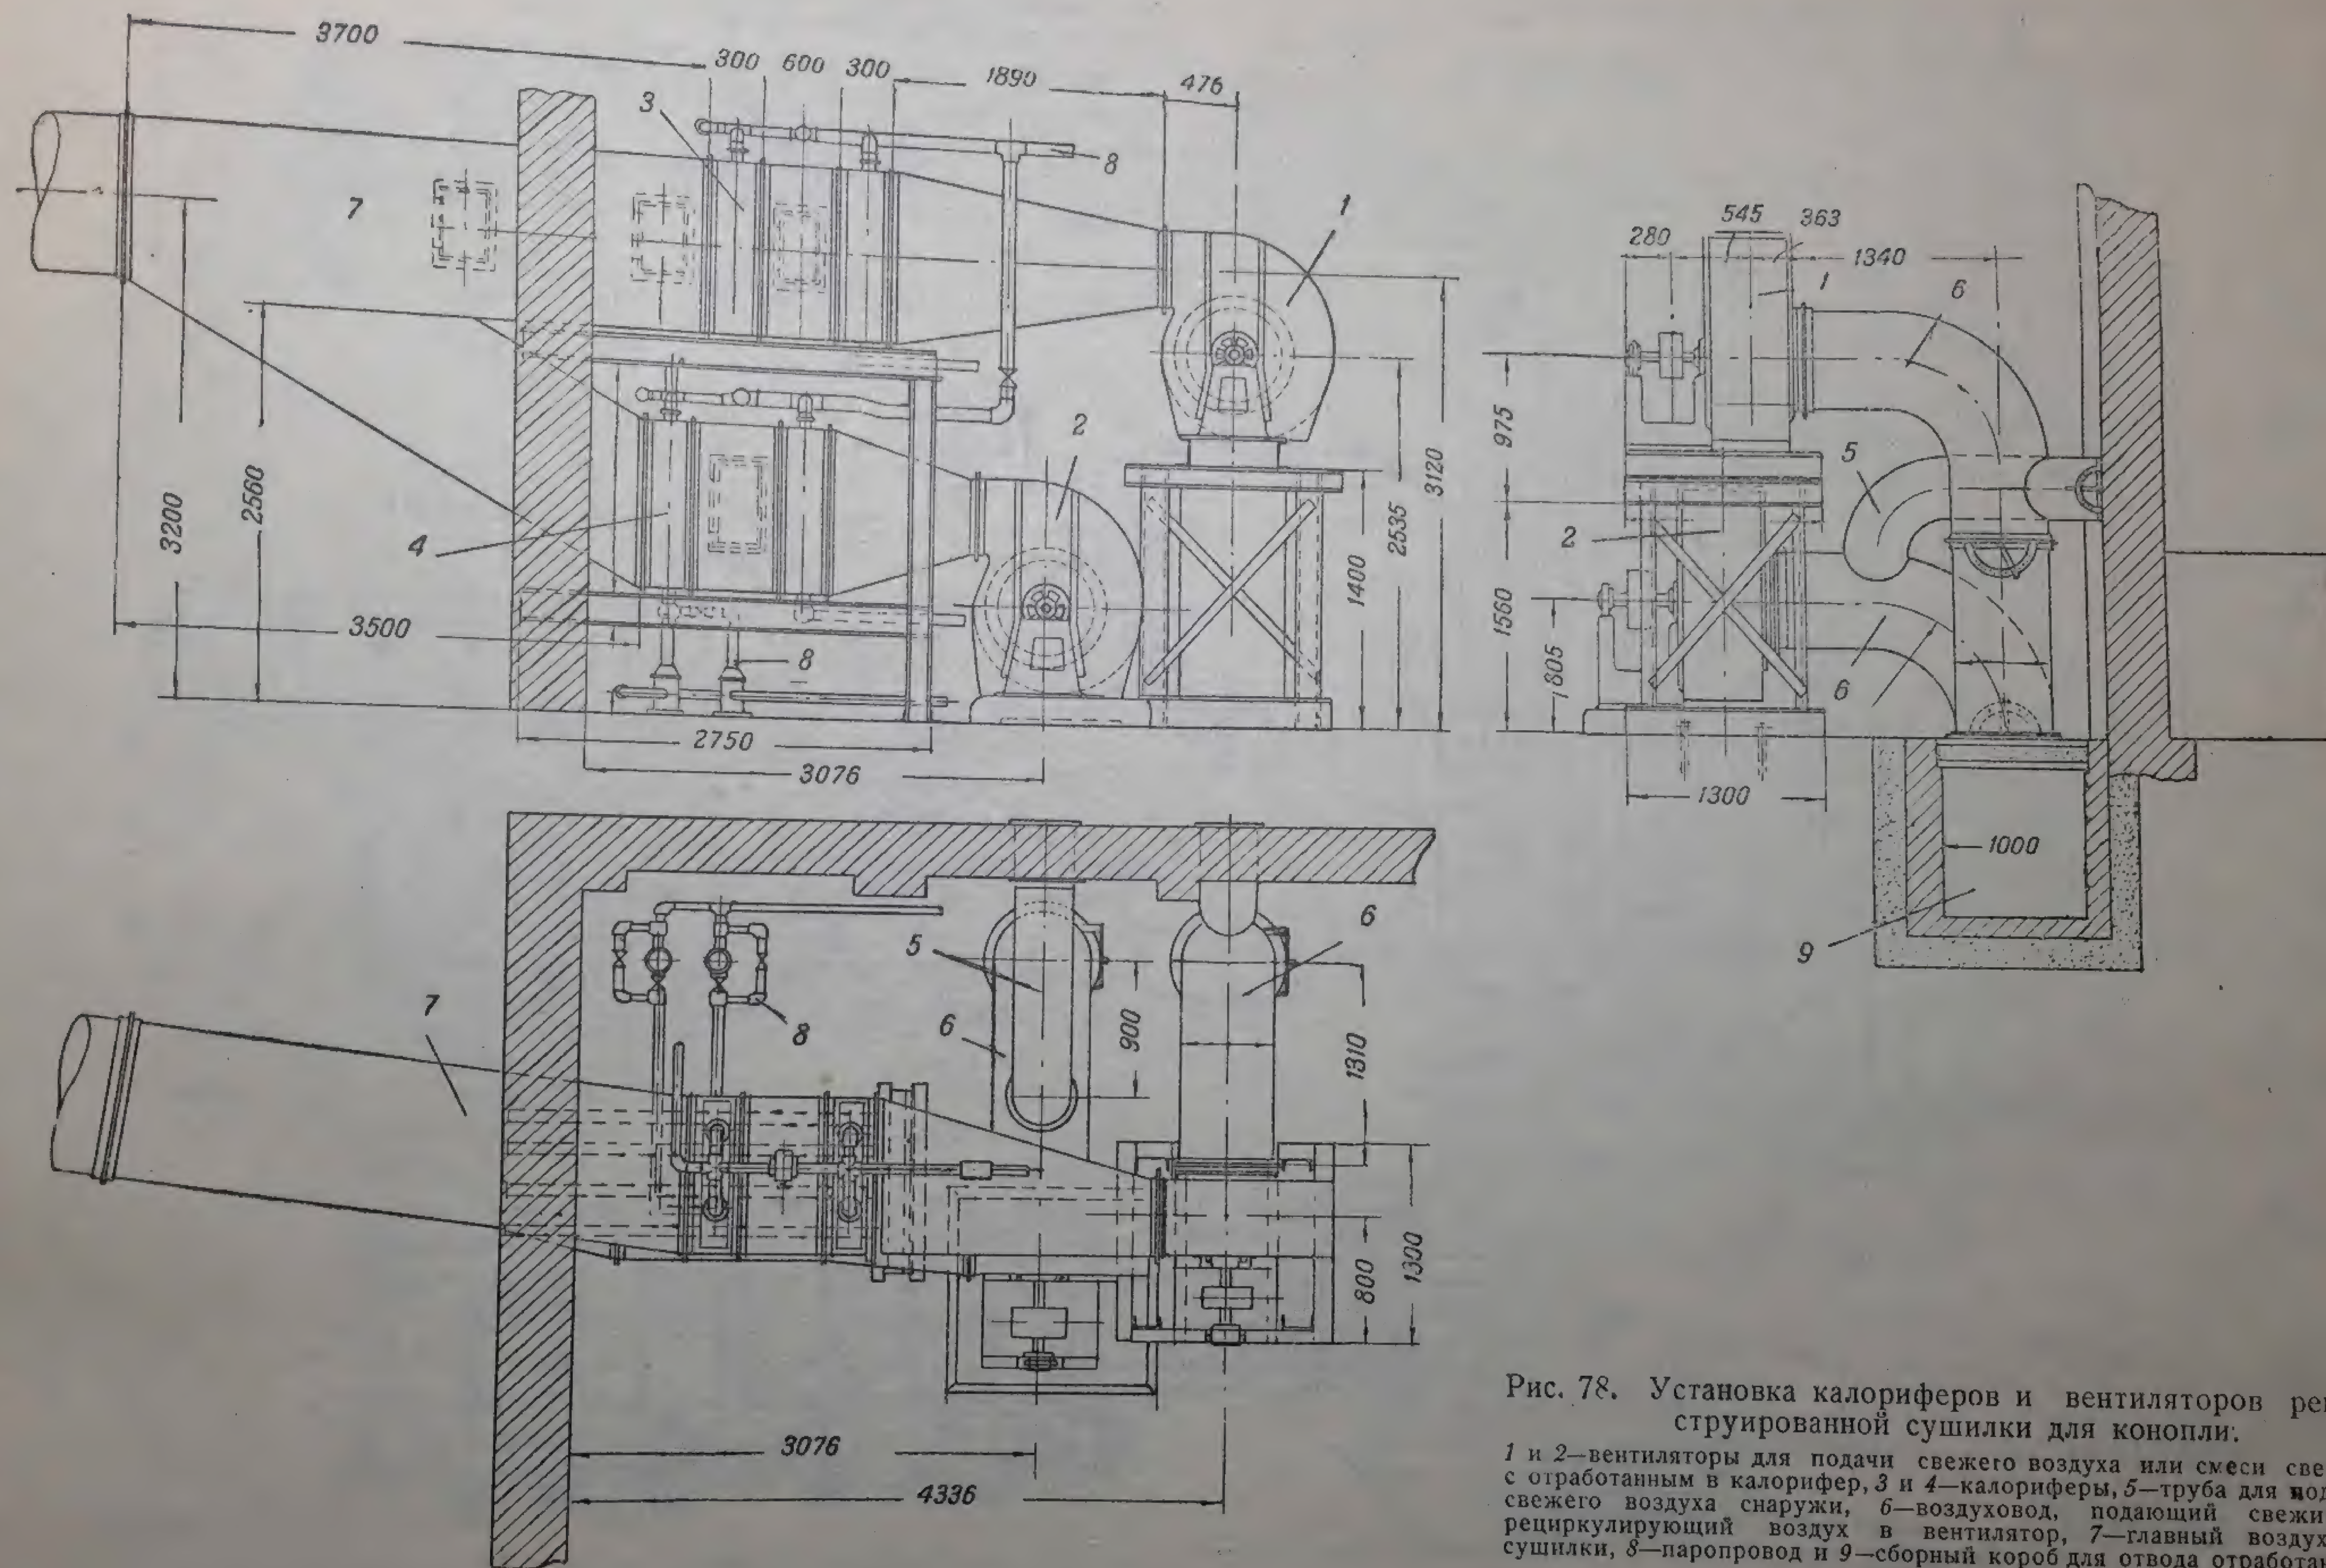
Установка калориферов и вентиляторов реконструированной сушилки для конопли.
